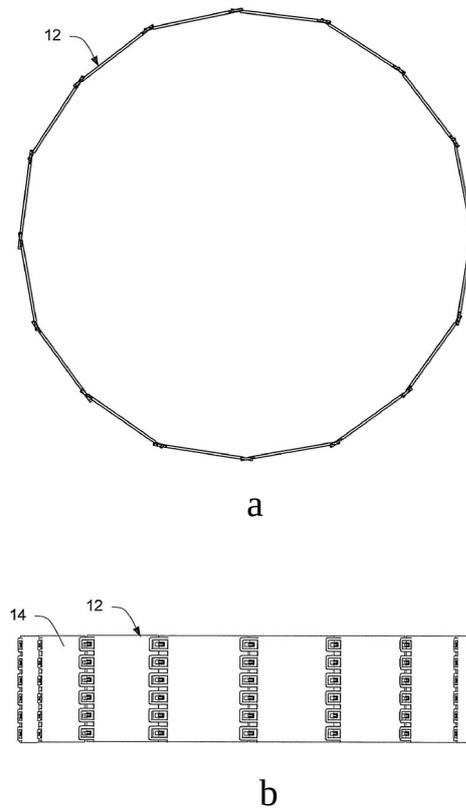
Схемы типовой подпорной стенки (a, b)
